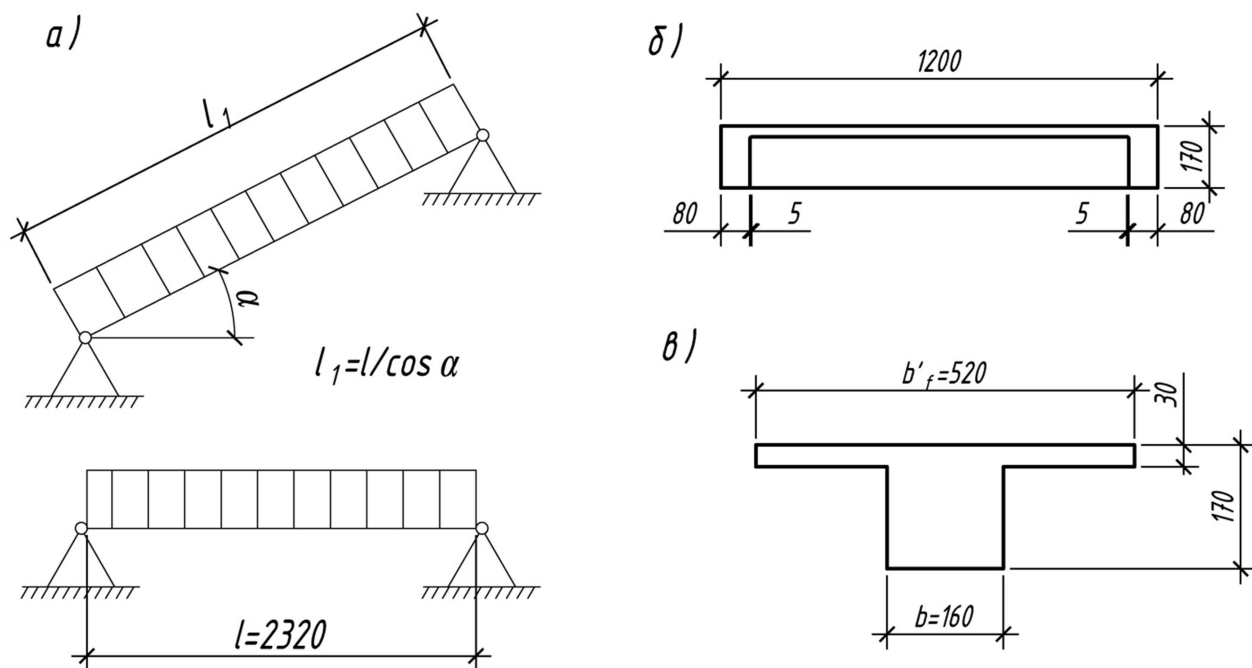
Детали сборной железобетонной двухмаршевой лестницы:
